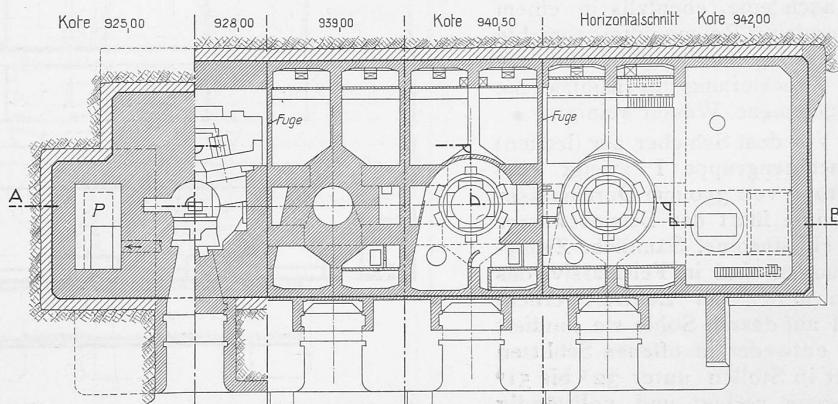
Abgestufter Horizontalschnitt des Maschinenhauses. — Masstab 1:600.
